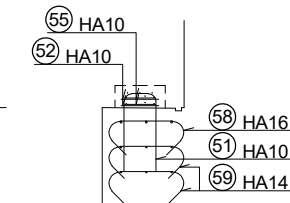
DETAIL ZONE D'APPUI / BEARING SURFACE DETAIL A3: 1/60 ; A1:1/30
